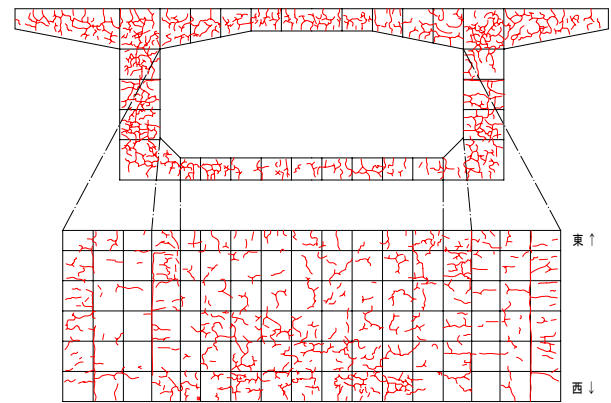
箱桁供試体 MODEL-A (収縮:大) のひび割れ状況展開図
